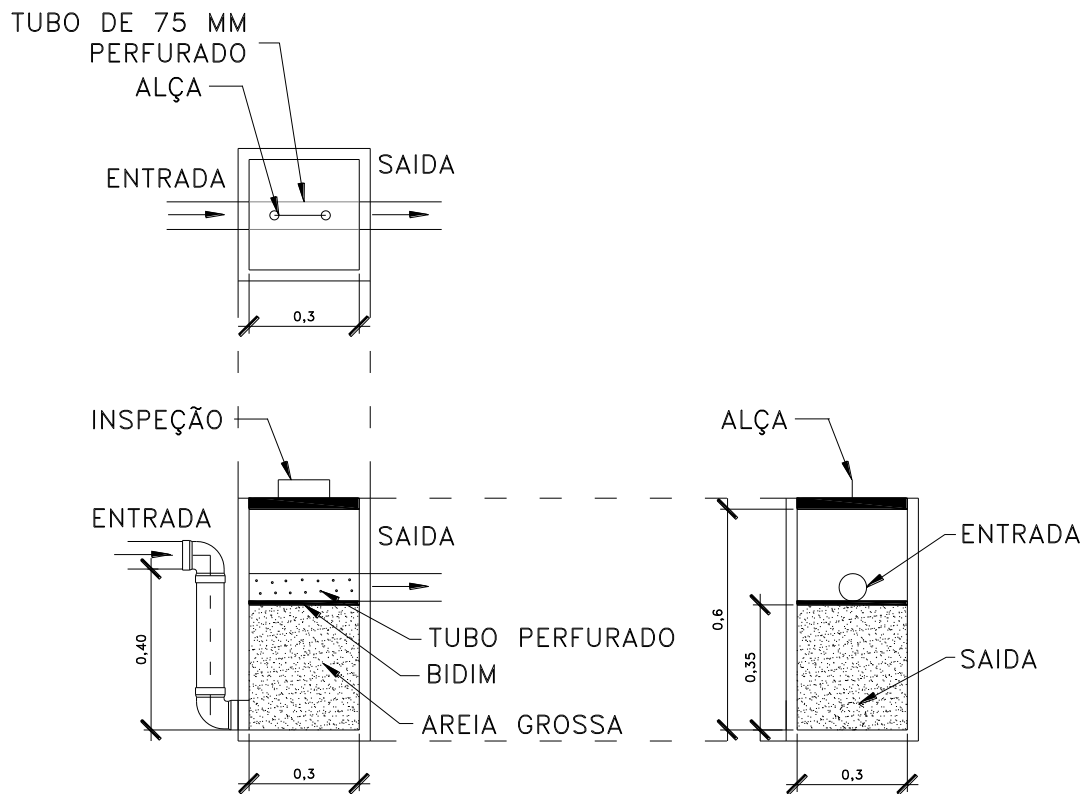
Desenho esquemático do projeto do filtro em planta, perfil e corte lateral.
